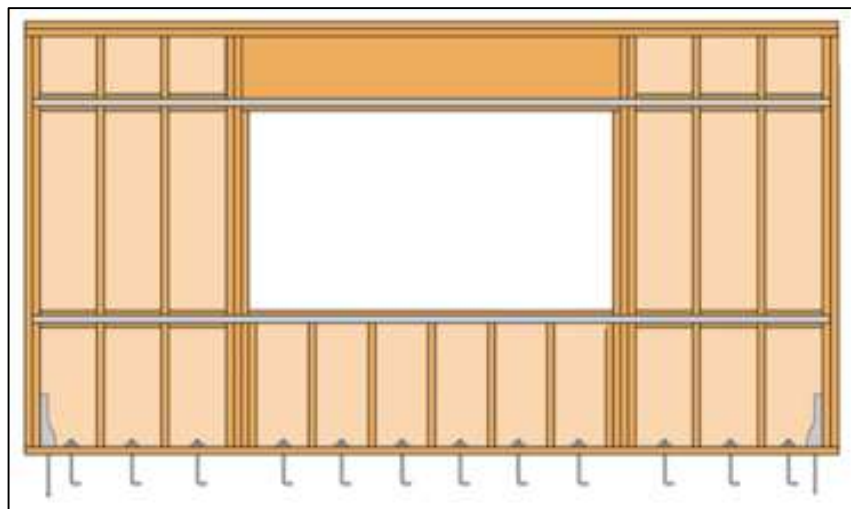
Muro de corte de madera acoplado por vigas y placas metálicas Fuente: (WoodWorks - Wood Product Council, 2016)
